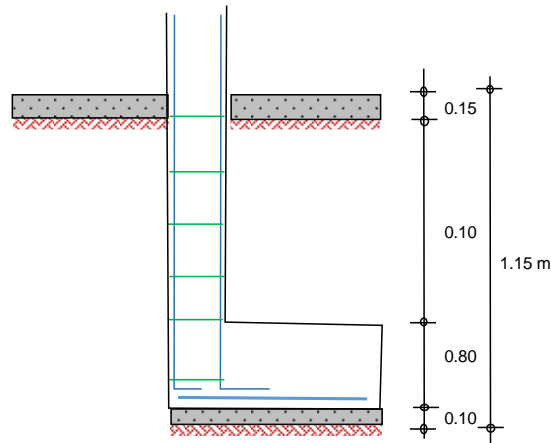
Detalle de sección de zapata esquinada (Estructura 2).
